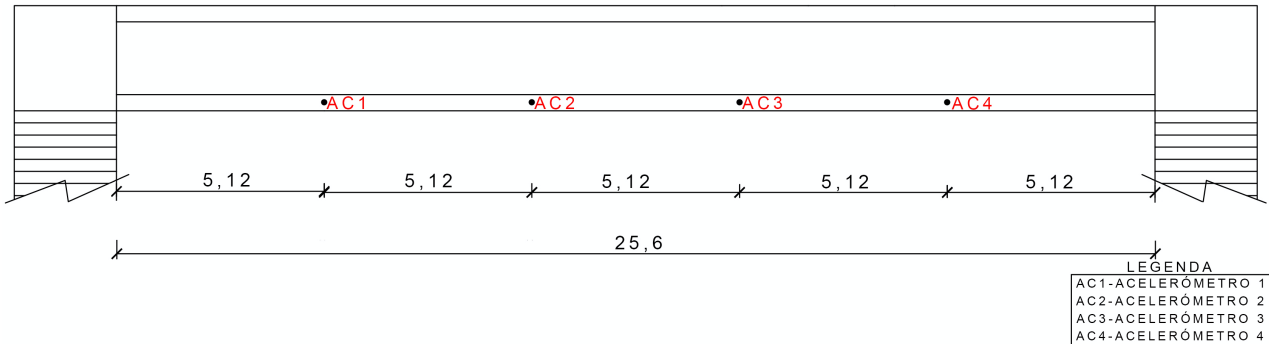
11: Esquema do posicionamento dos acelerômetros na viga longitudinal norte (dimensões em metros).
